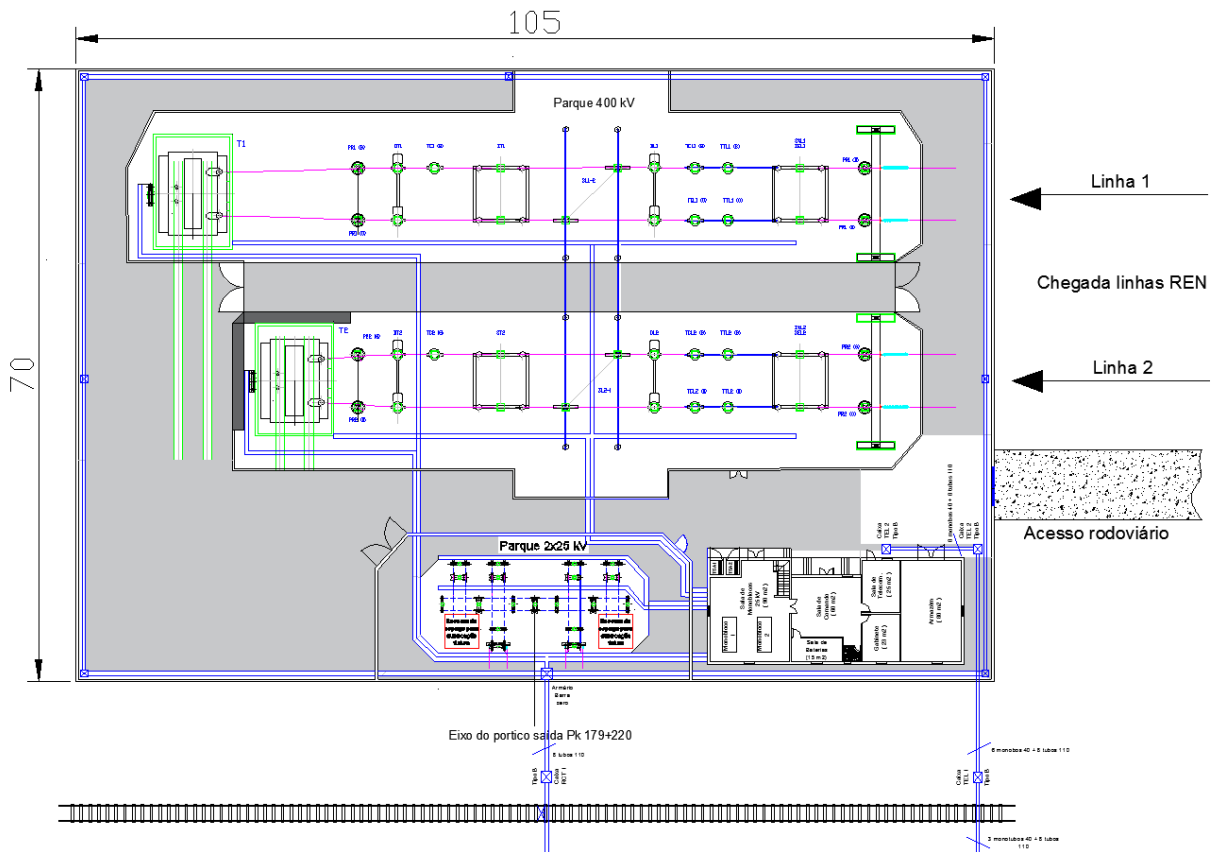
Implantação tipo prevista para a SST Alandroal (105x70m)
